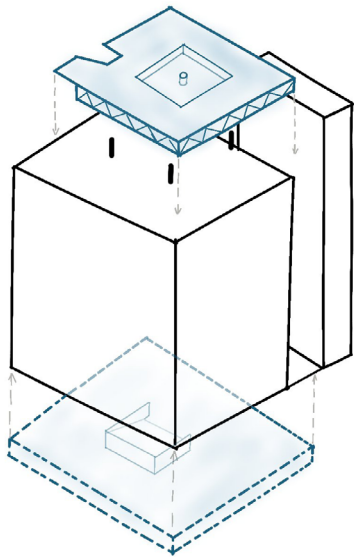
Construcción de un nuevo elemento en la cubierta y en el sótano. (Autoría propia, 2021).
